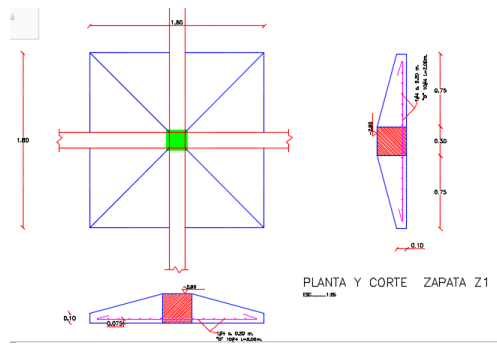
MODELO ESTRUCTURAL DE ZAPATAS
